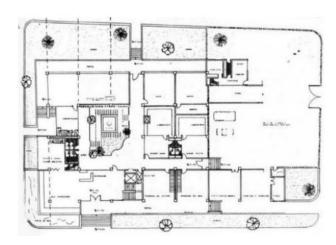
Plano de planta baja, MAG. Fuente: Libro BAQ (1980)
